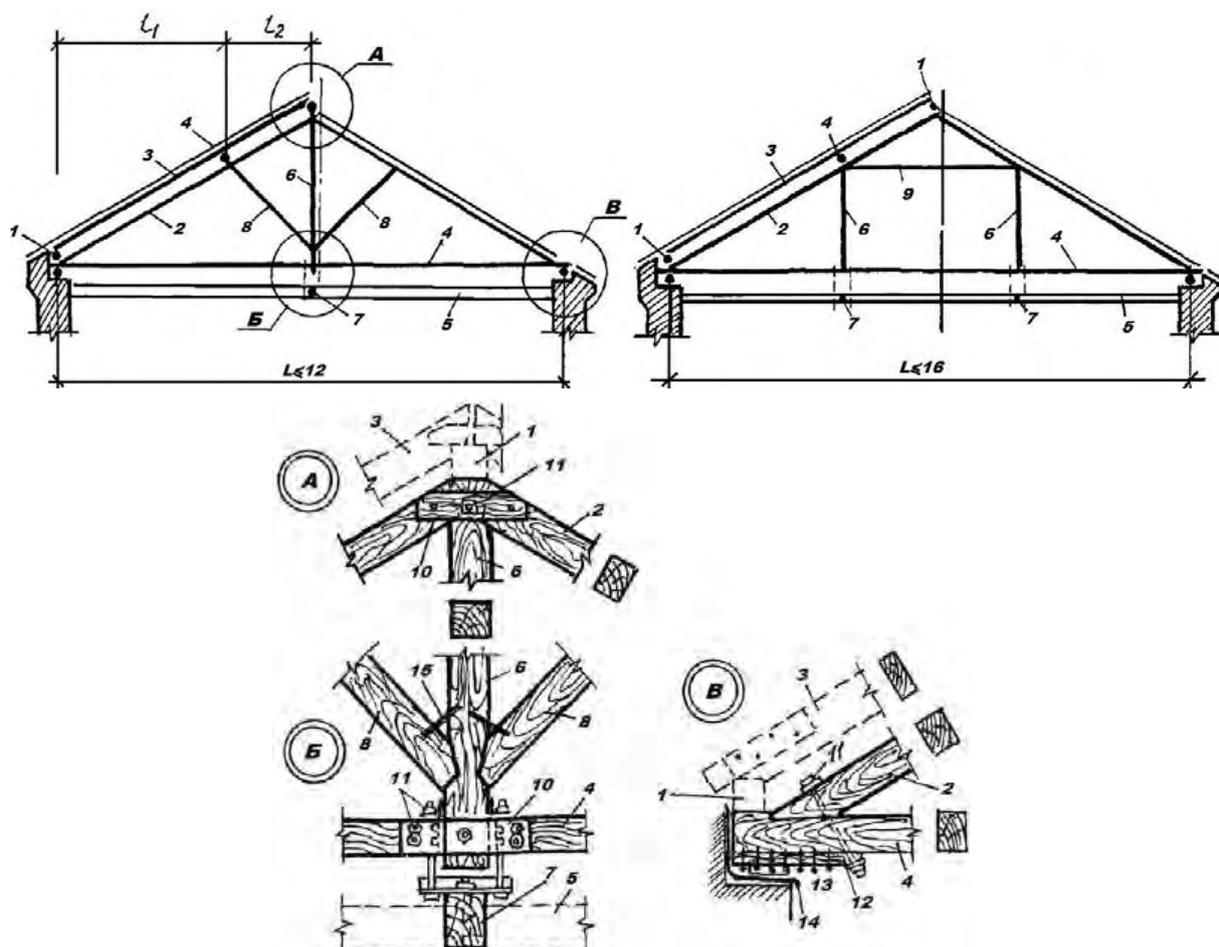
Висячие стропила скатных крыш: 1 — прогон; 2, 4 — верхний и нижний пояс ферм; 3 — стропильная нога; 5 — балки чердачного перекрытия; 6 — стойка; 7 — прогон чердачного перекрытия; 8 — подкос; 9 — ригель; 10 — накладки из досок; 11 — болт; 12 — прибоина; 13 — антисептированная подкладка; 14 — толь; 15 — скоба
